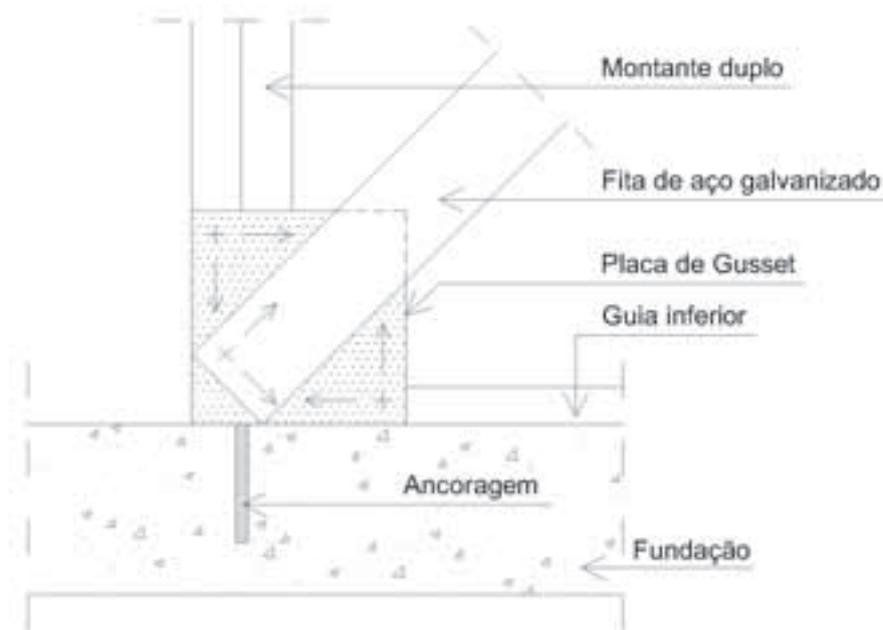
Fixação das diagonais nos painéis por placa de Gusset
